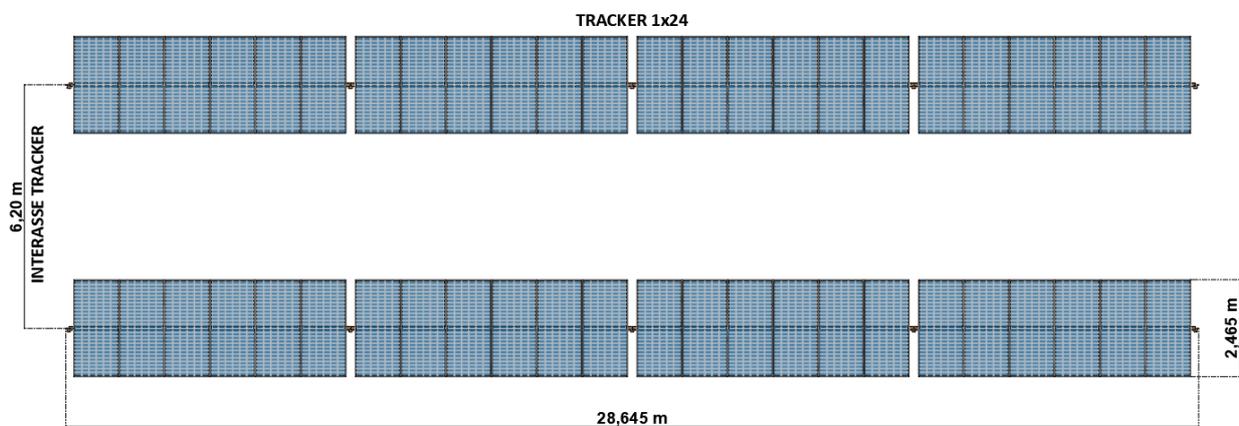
Vista in Pianta delle strutture (c.d. tracker)
